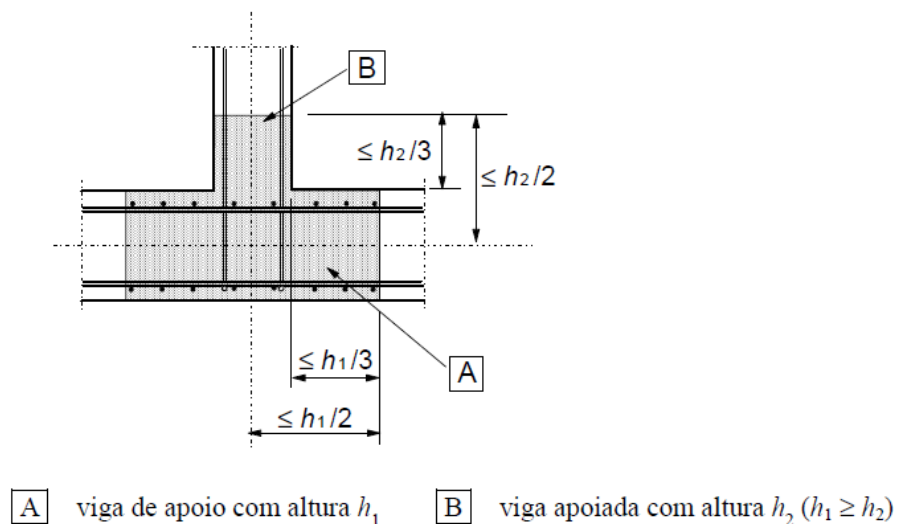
Colocação da armadura de suspensão na interseção das duas vigas
